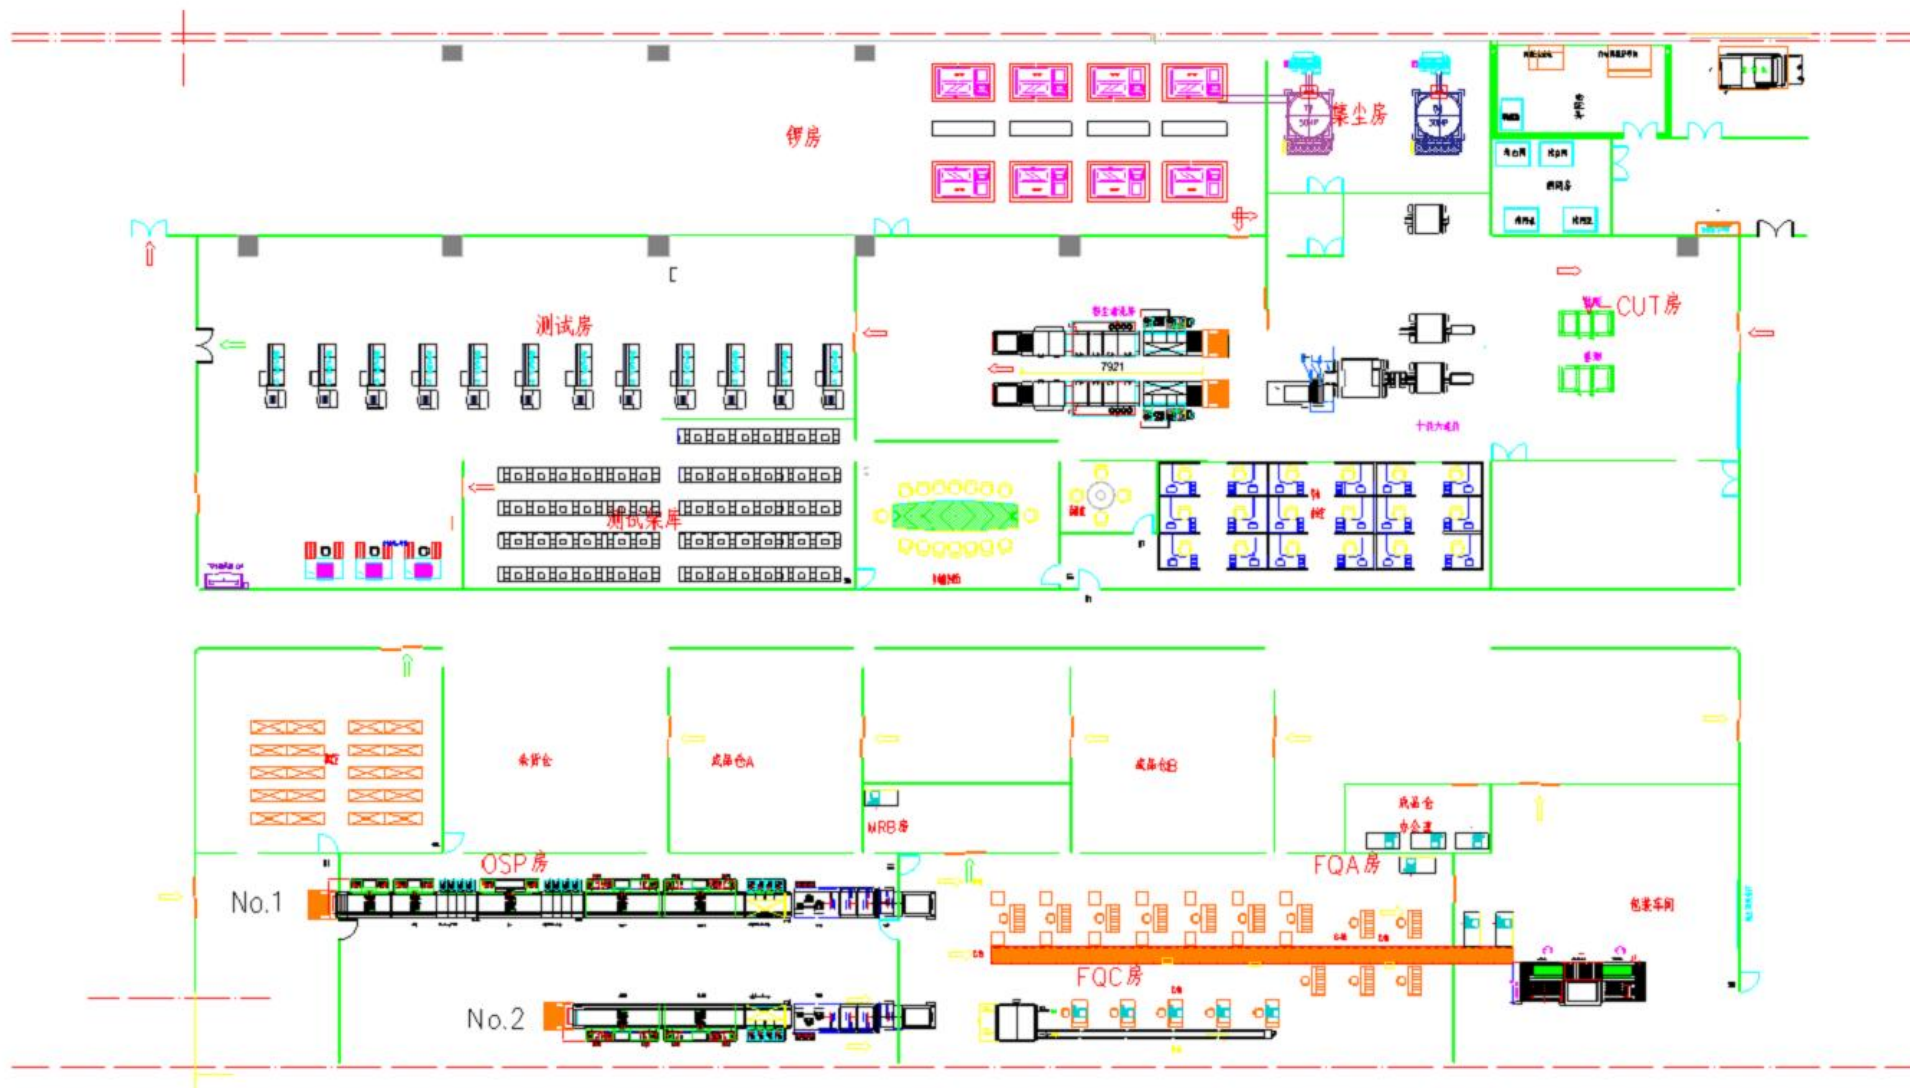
本项目二号厂房 5 楼实际平面布置图
